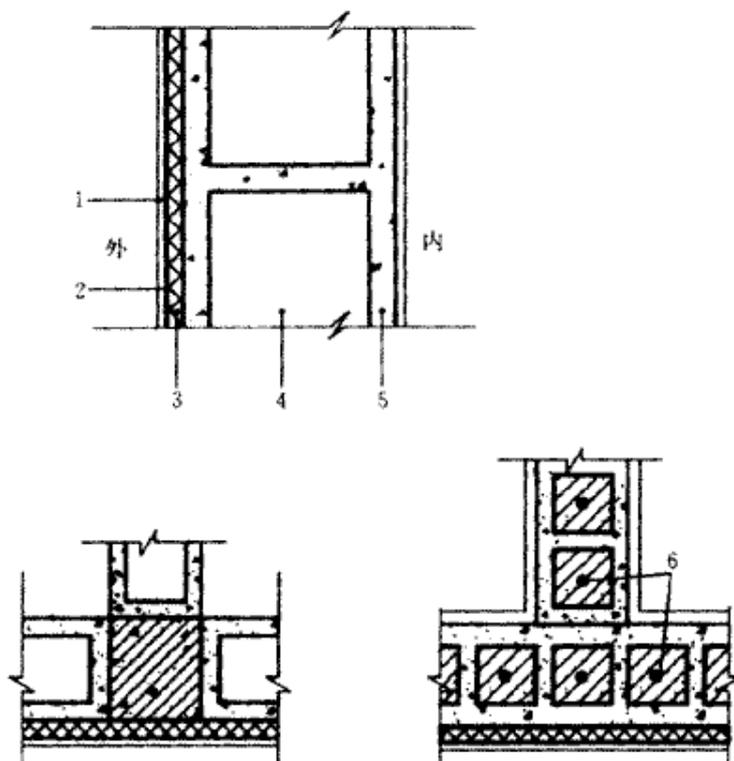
混凝土空心砌块外墙外保温构造做法
